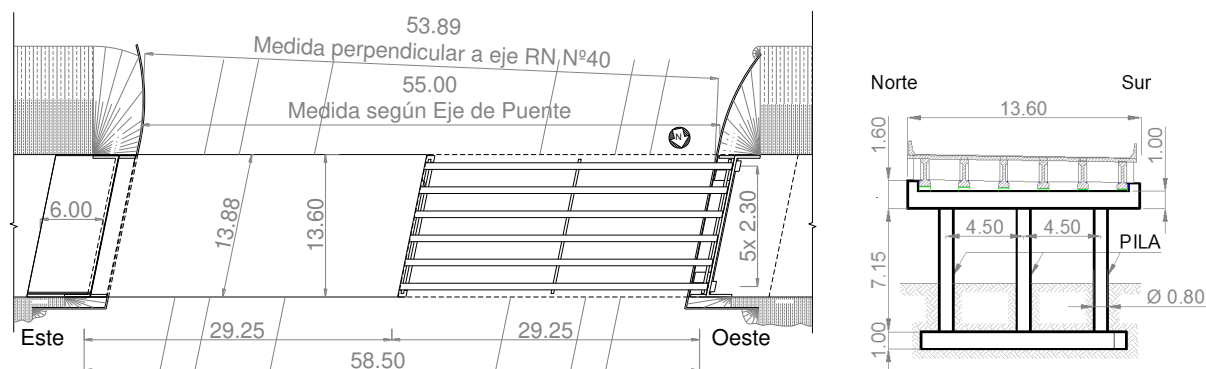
Vista en planta y corte transversal del puente. Medidas en metros.
